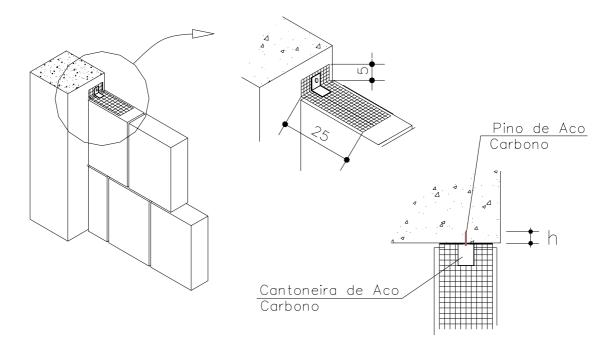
Detalhe típico da ligação da estrutura de concreto armado com alvenaria através da colocação de uma tela metálica
